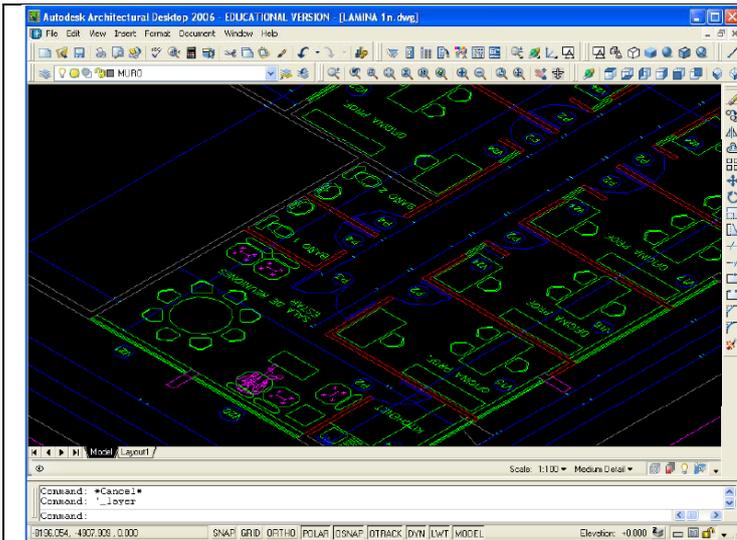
Plano en 2D, donde vectores (layers) representan en planta muros, ventanas, puertas, etc.
